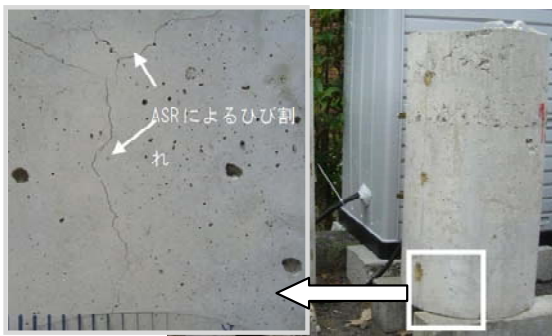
屋外暴露したプロピオン酸カルシウム無添加の大型コンクリート供試体のひび割れ状況(図 8 の 946 日の観察)
